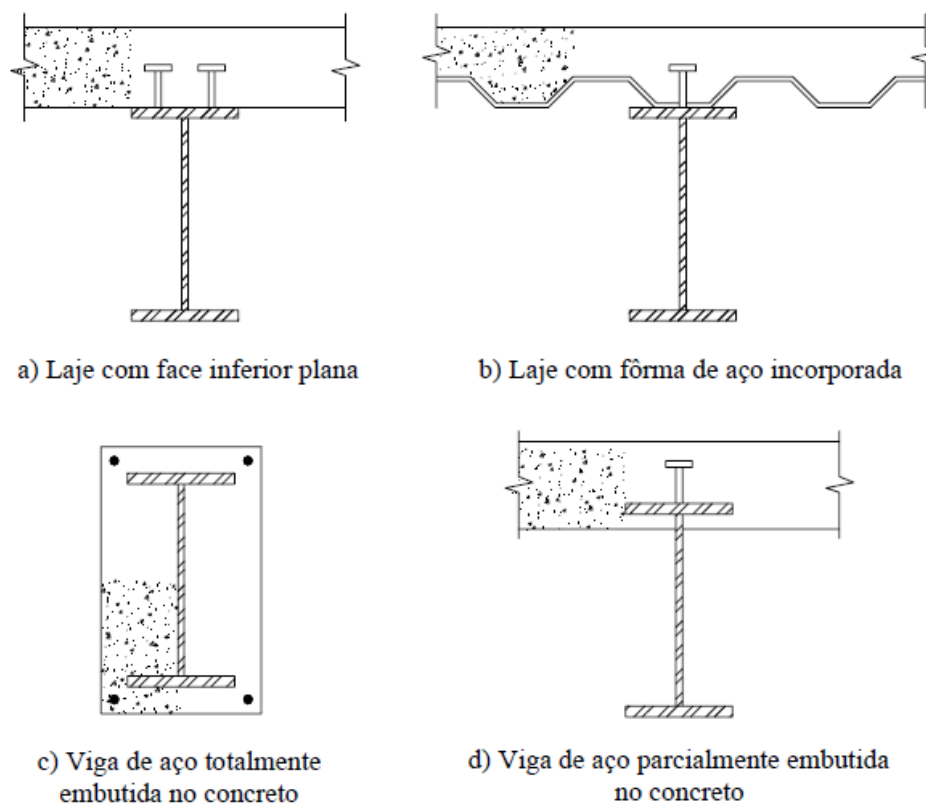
Tipos mais usuais de seções transversais de vigas mistas (Alva, 2000)
